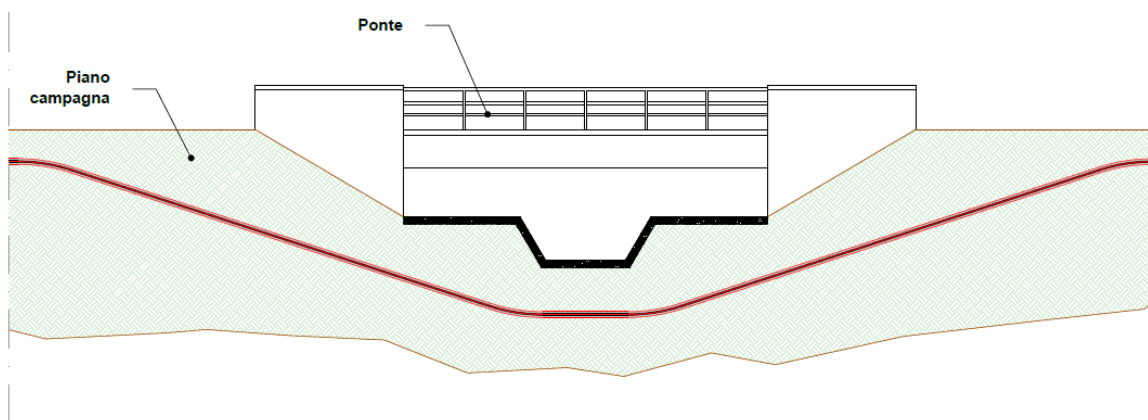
Sezione tipo attraversamento ponte con T.O.C.
